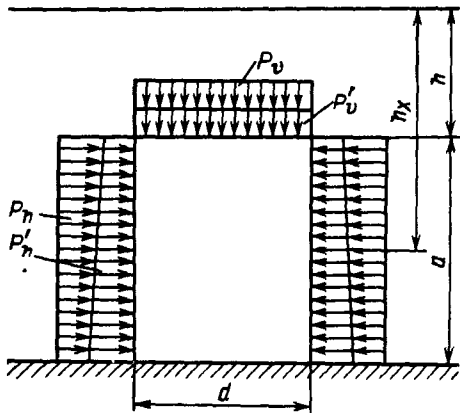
Эпюра давления от собственного веса грунта и временной подвижной нагрузки на конструкцию туннеля
